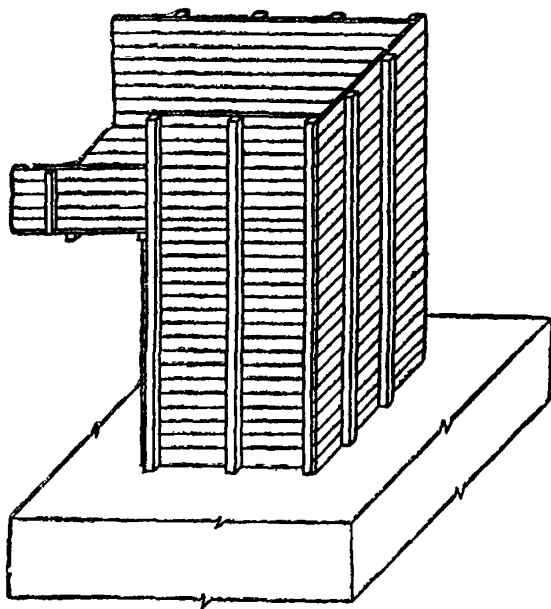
Плоская опалубка с каркасом из досок и брусьев
